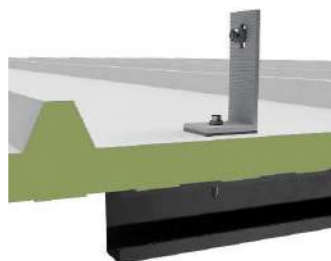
Suporte em L, para perfil corrido, cobertura metálica.
